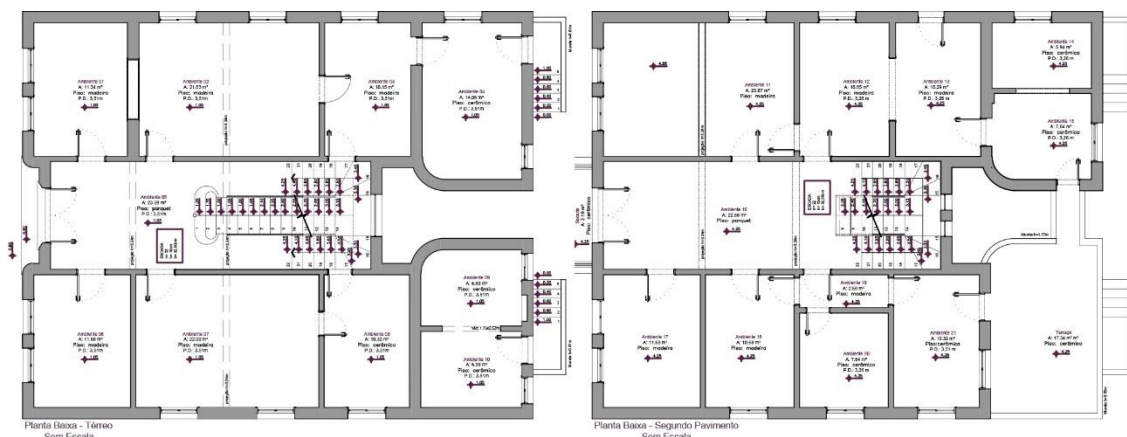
Plantas baixas do térreo e segundo pavimento da Residência.
